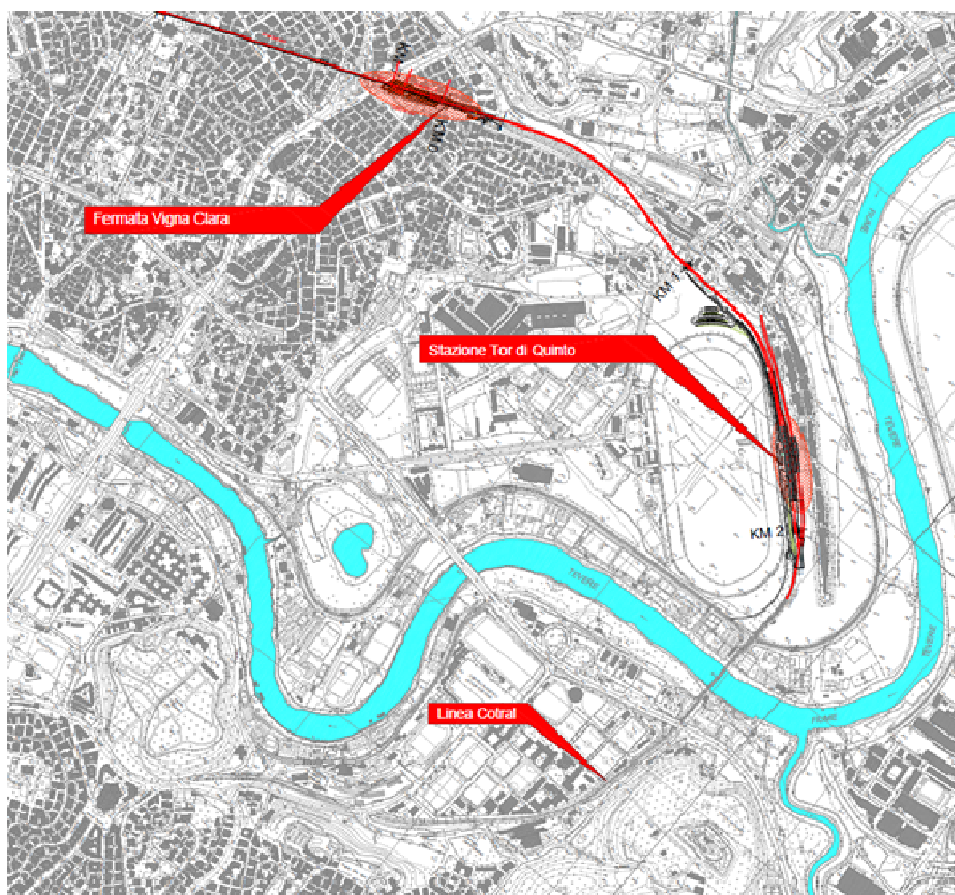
Stralcio planimetrico Tratta Vigna Clara – Stazione di Tor di Quinto
